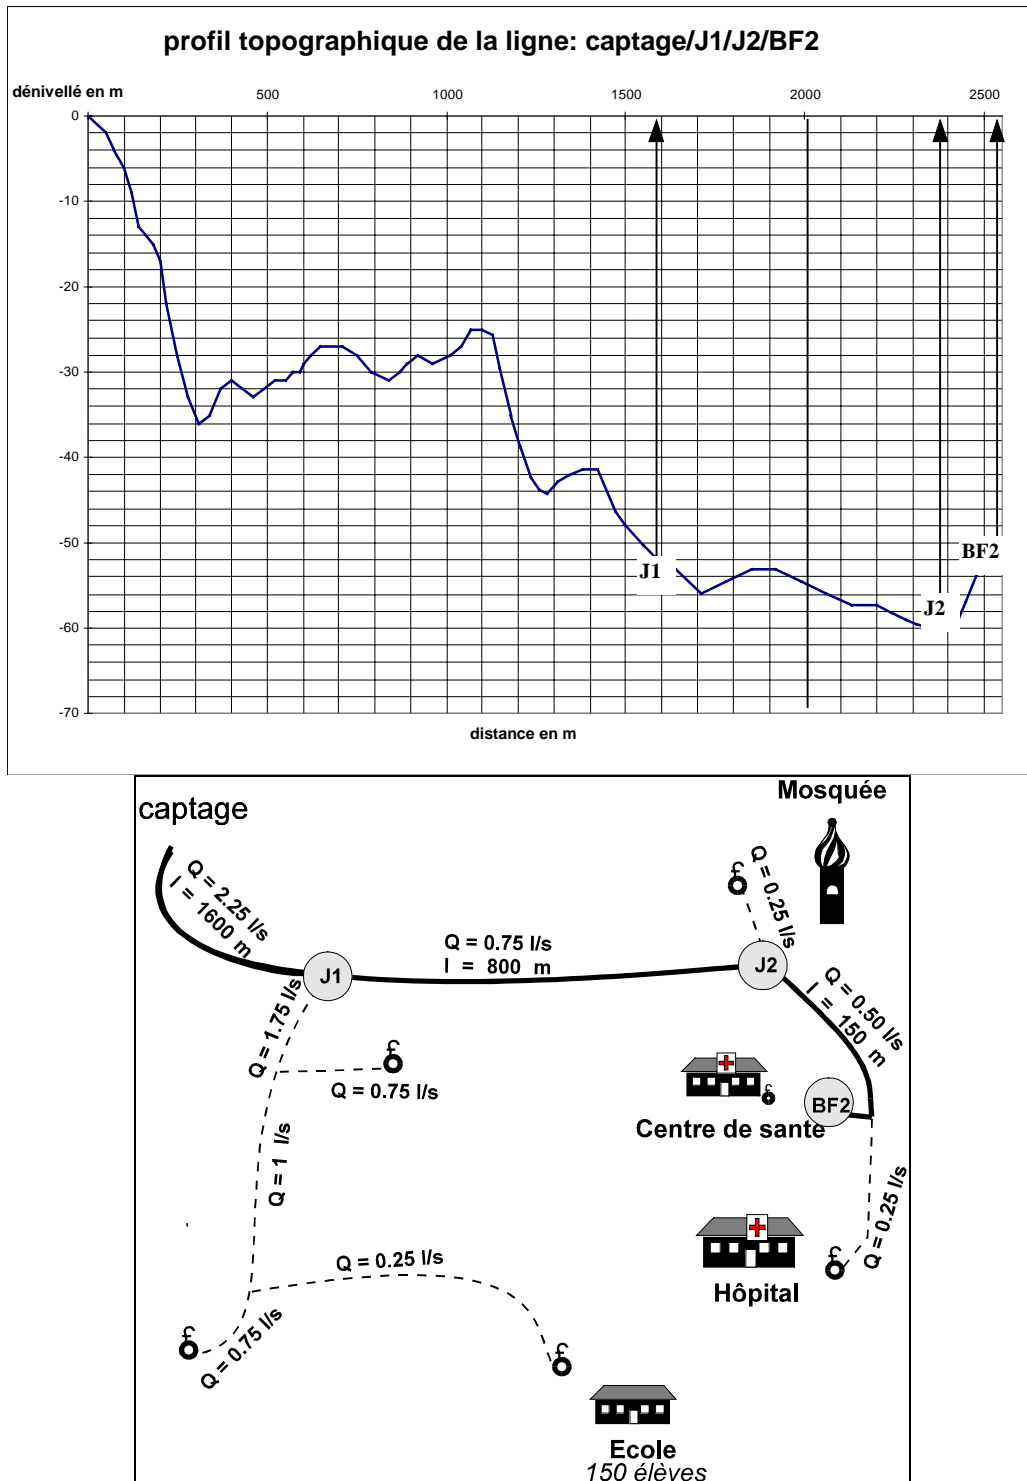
profil topographique et plan de masse -tracé captage/J1/J2/J3/BF2 - Aloua
